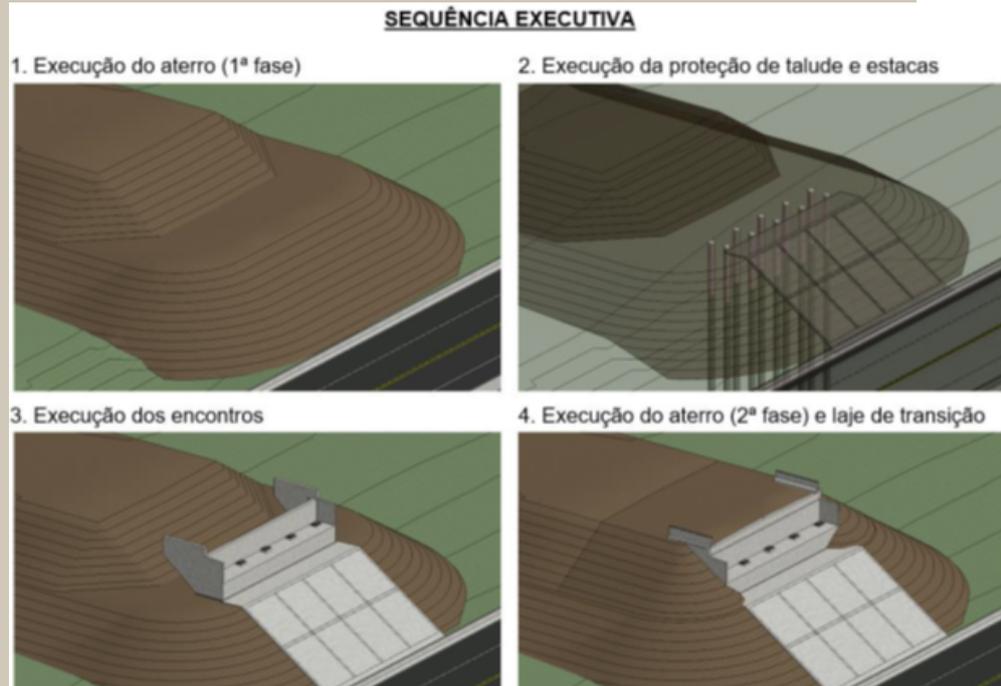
Sequência parcial de execução de ponte de vigas pré-moldadas sobre encontro leve com fundação profunda, sobre aterro estabilizado
